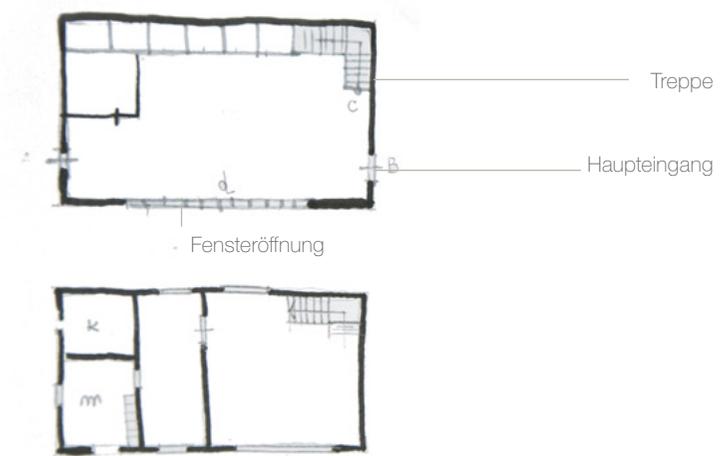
Zweigeschossige Hüttenhäuser, Grundrisse
